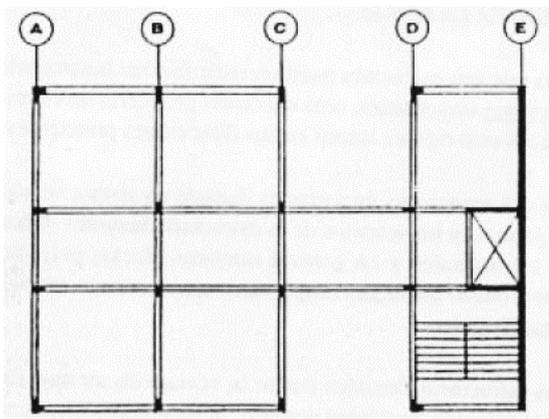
, Planta de edificio con mucha rigidez en extremo y con reducción de losa en planta.
